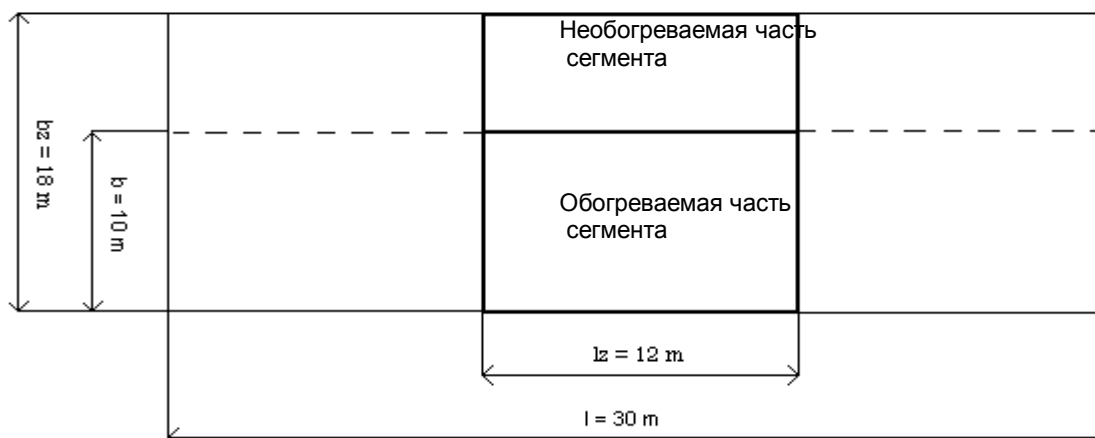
Горизонтальная проекция сегмента здания – первый этаж
